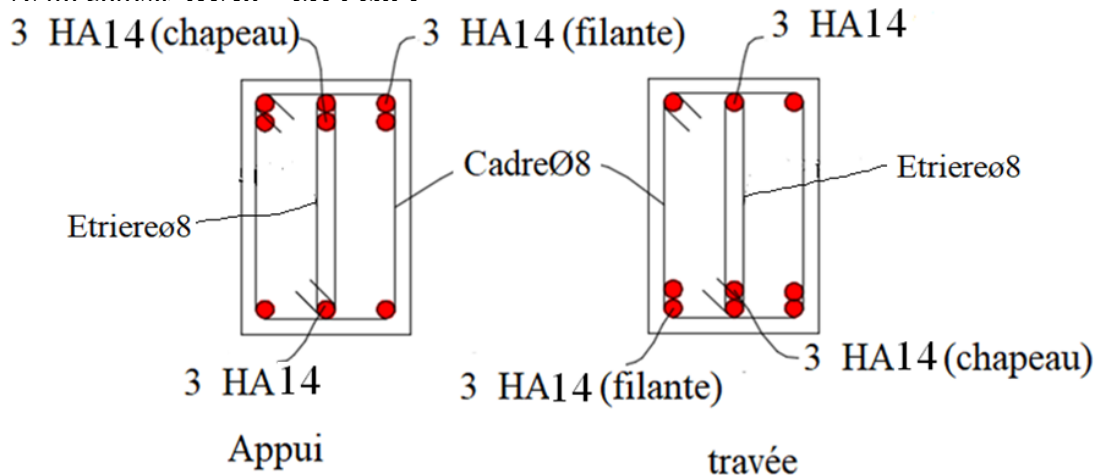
Schéma de ferrailage de la poutre de chaînage
